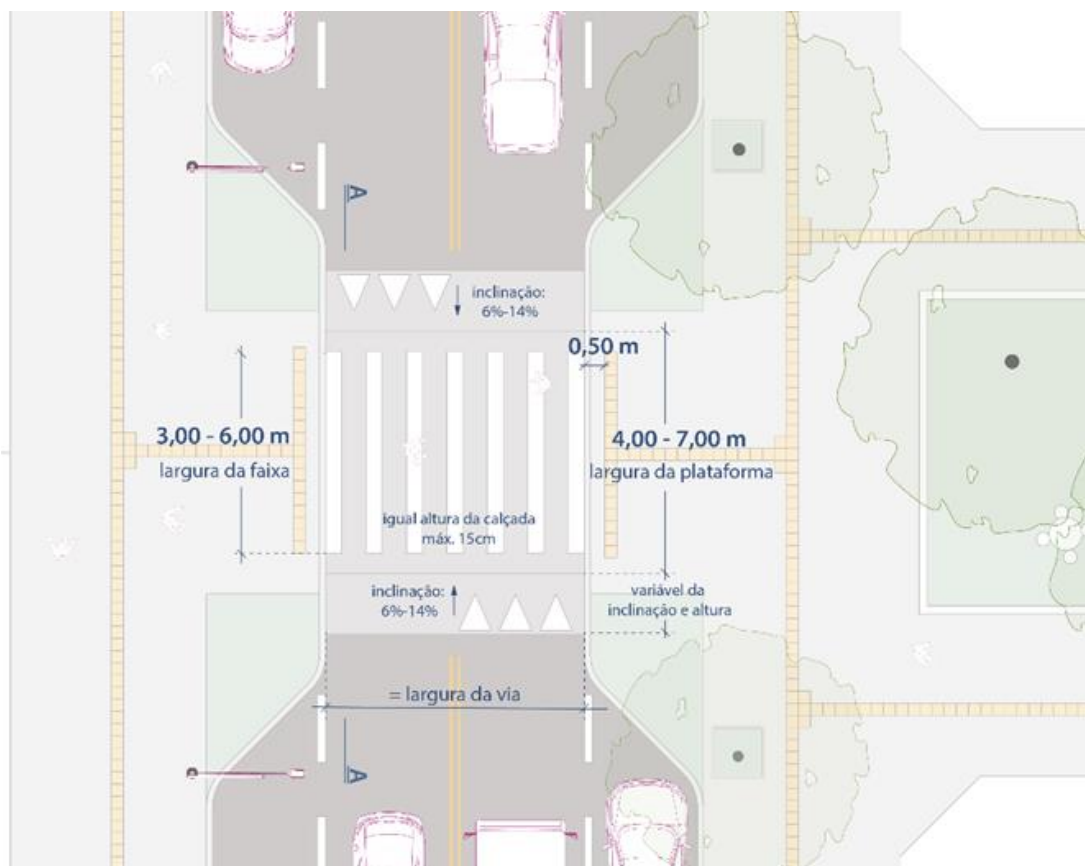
Dimensionamento de faixa elevada para travessia de pedestres em planta.
